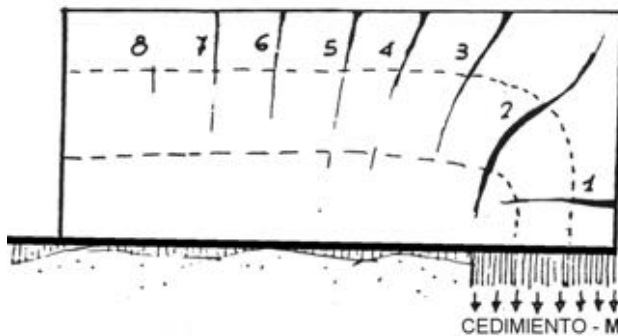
TIPOLOGIAS DE GRIETAS POR CEDIMIENTO DE UNA ESQUINA
